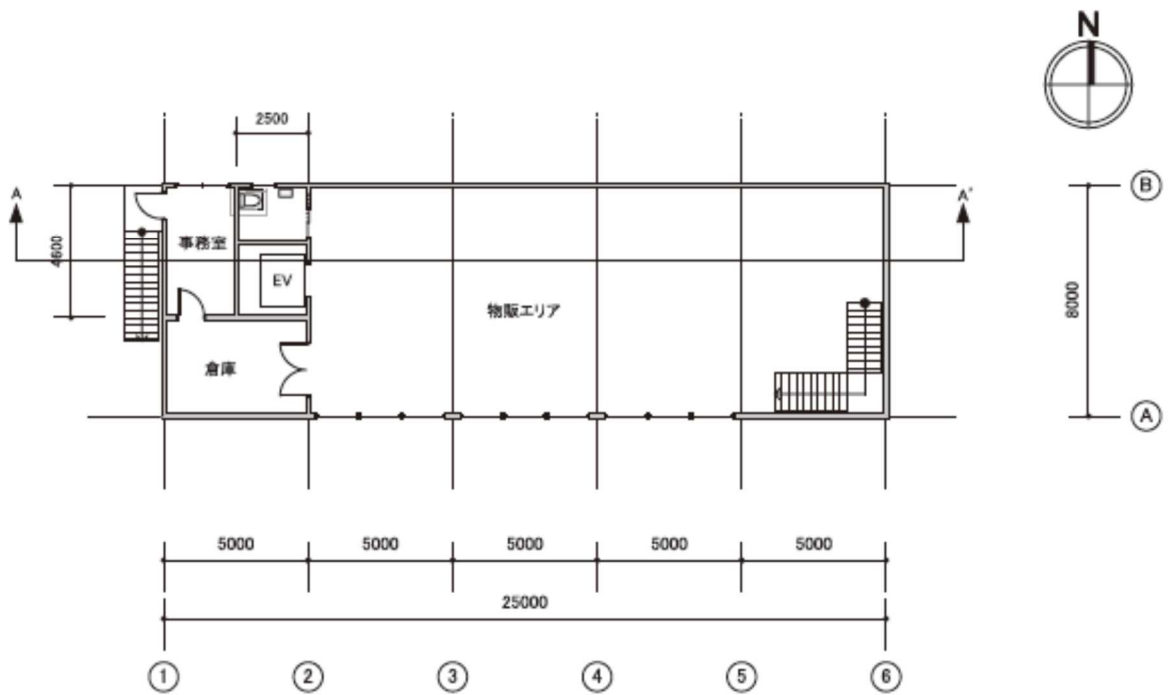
9 モデル建物（小規模物販店舗等） 2階平面図
